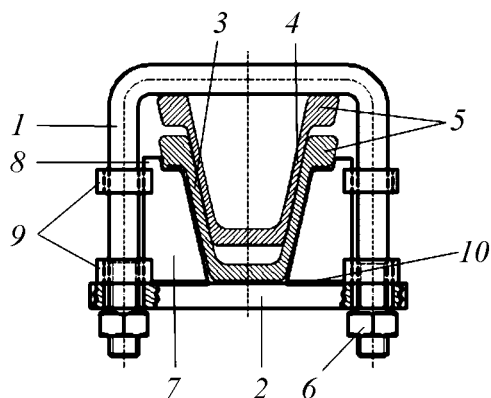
Принципиальная схема замкового устройства для арочного крепления из спецпрофиля: 1 – скоба, 2 – планка, 3 и 4 – внутренний и внешний спецпрофили, 5 – фланцы, 6 – гайки, 7 – вкладыши, 8 – выступы, 9 – крепление, 10 – сварное соединение
